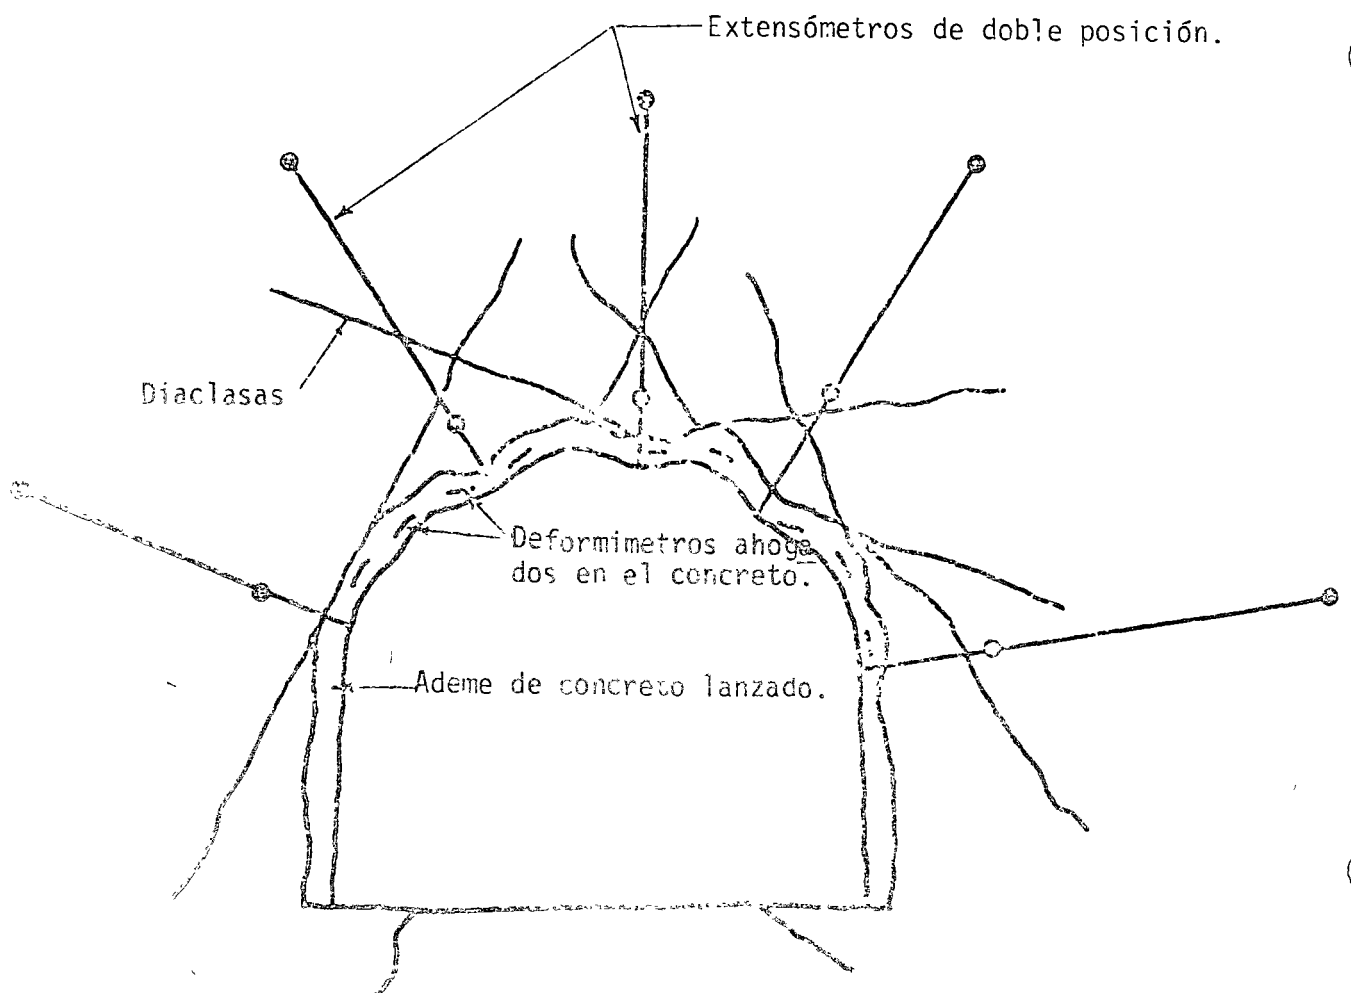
B. Instrumentación para un túnel ademado con concreto lanzado.
